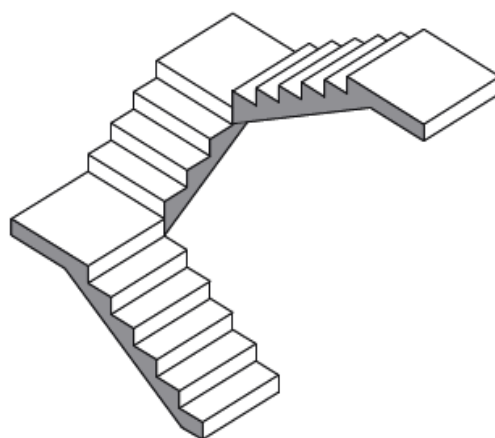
Escalier à trois paliers et deux paliers intermédiaires
